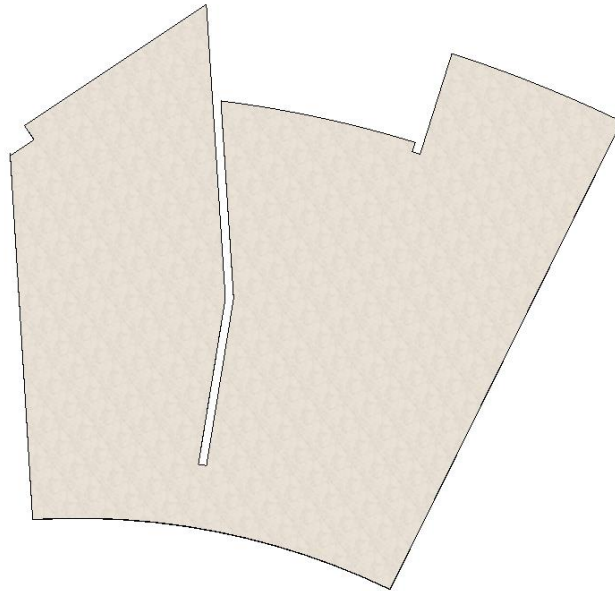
Alternatif 2 Rencana Lantai *Deluxe Room
